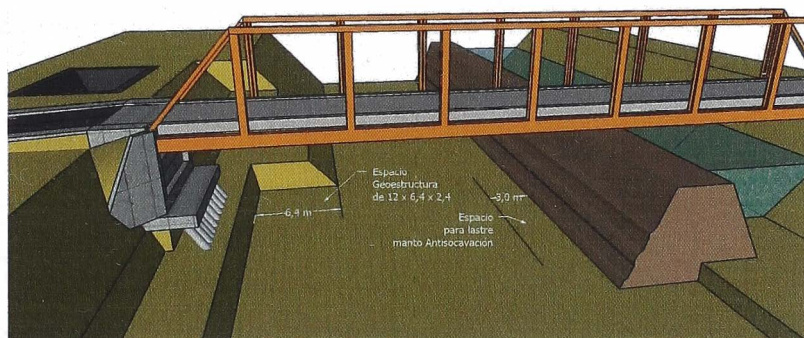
Esquema de localización de lastre y Geoestructura de protección
